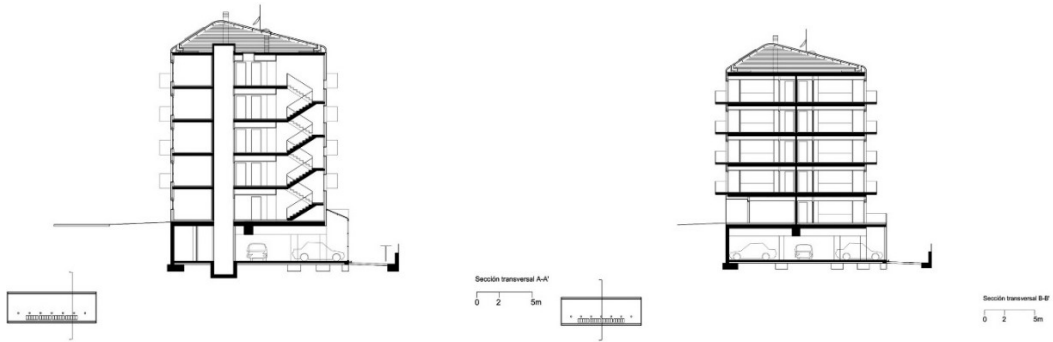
Denah Bangunan Social Dwelling di Spanyol
